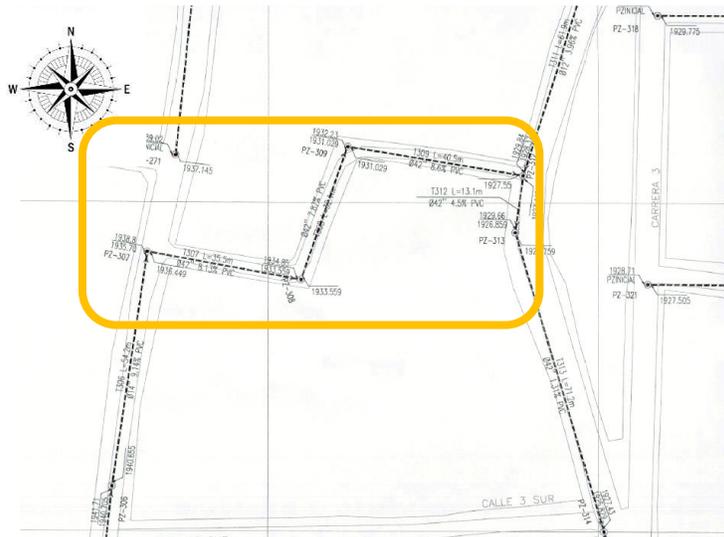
Trazado de la red de alcantarillado pluvial sector Calle 2 Sur entre Cra 3 y Cra 4
